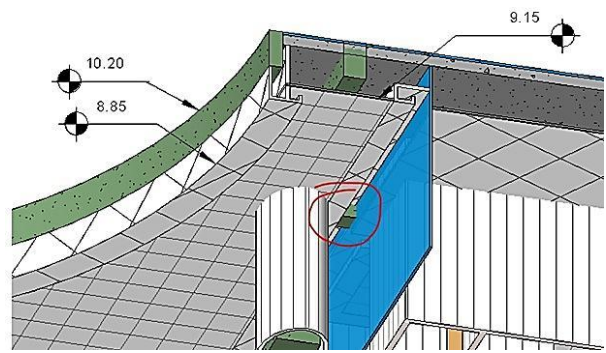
Viga de concreto expuesta bajo las cenefas y FCR.
